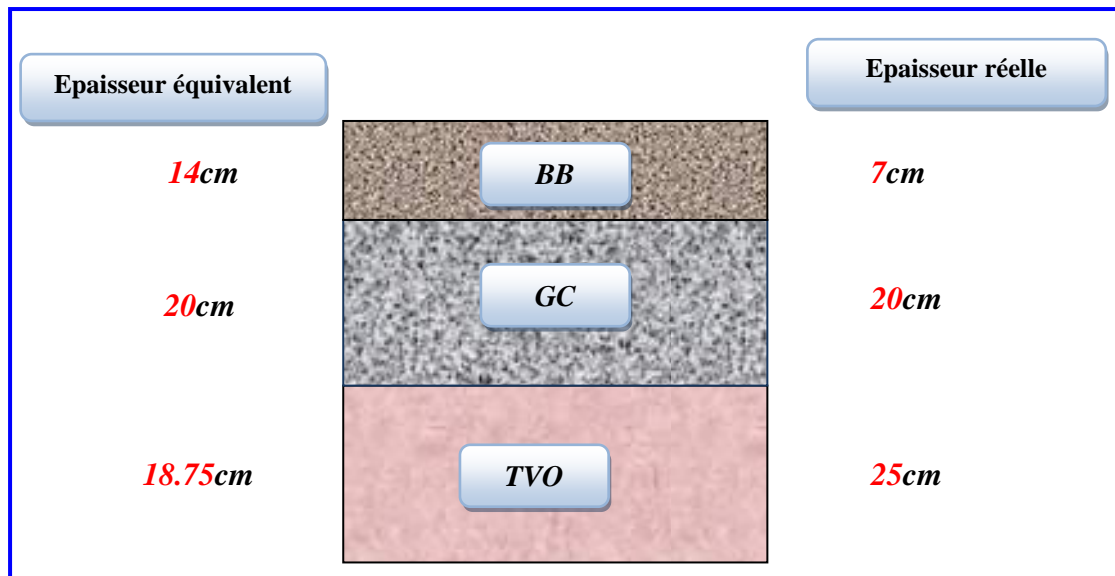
Détail de différentes couches du corps de chaussée.
